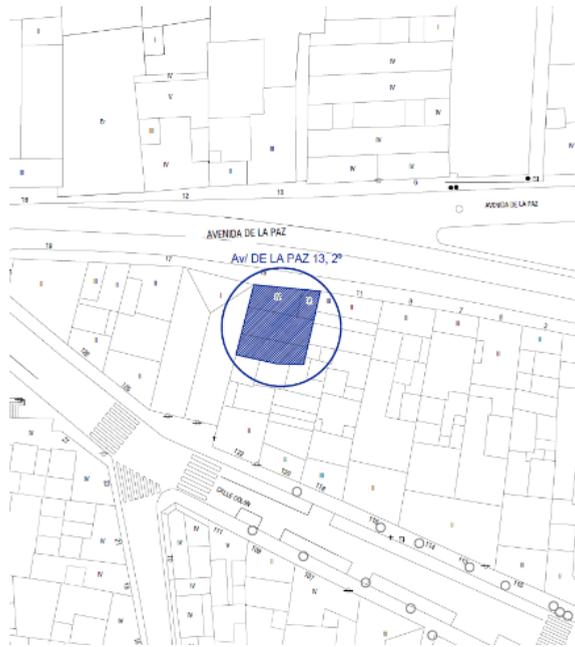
Emplazamiento del edificio. Fuente propia.
